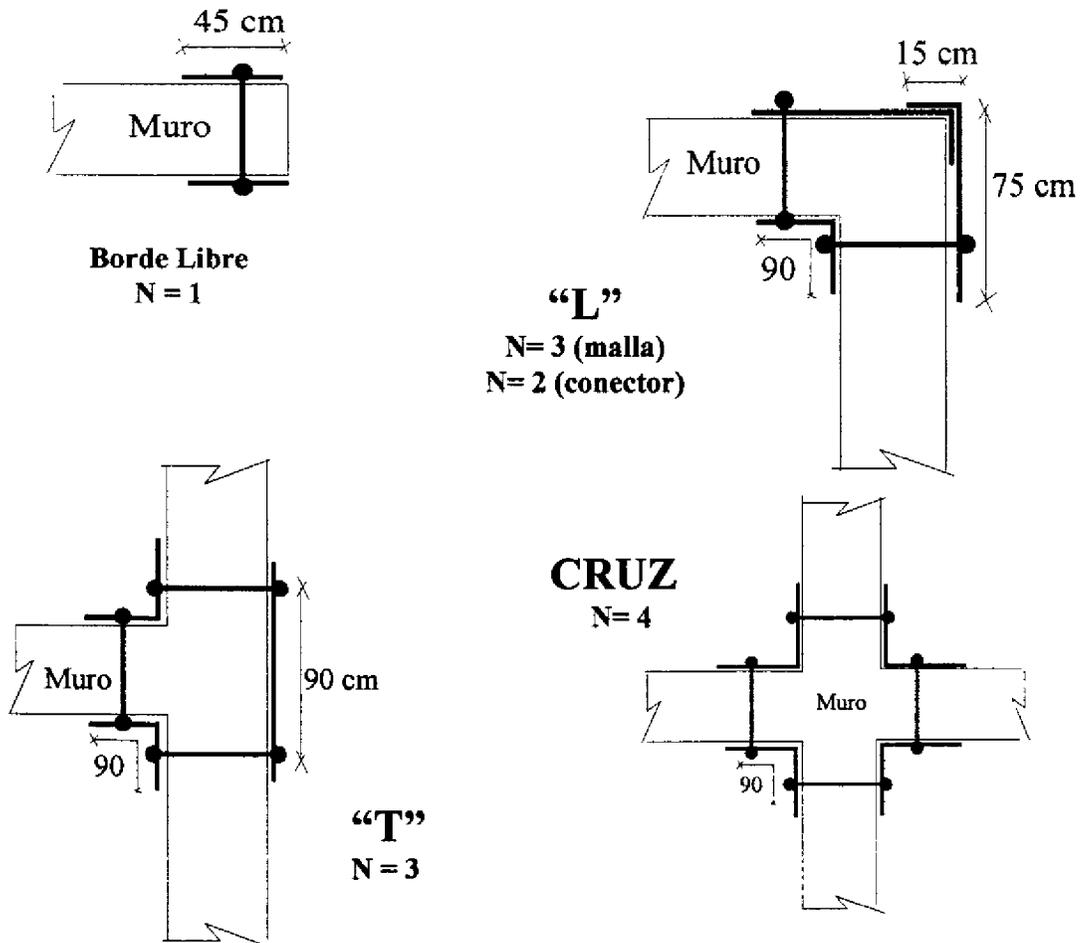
Valores "N" para diversos encuentros en planta de los muros interiores y conectores de las mallas verticales
